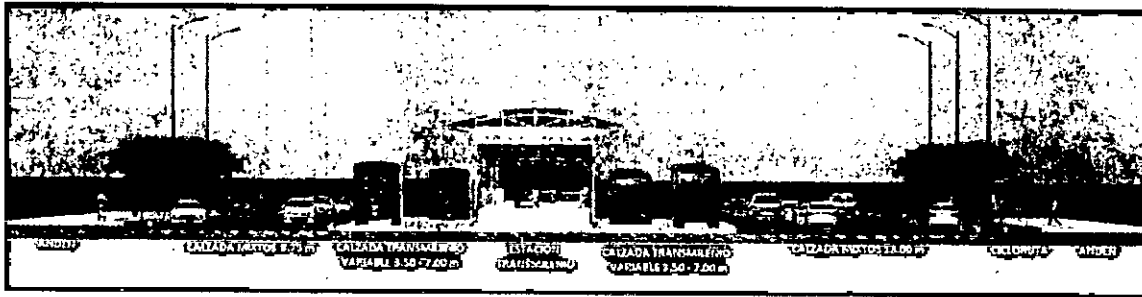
Sección transversal típica en estación tramo 5 desde la Avenida Suba hasta la Avenida San José.
